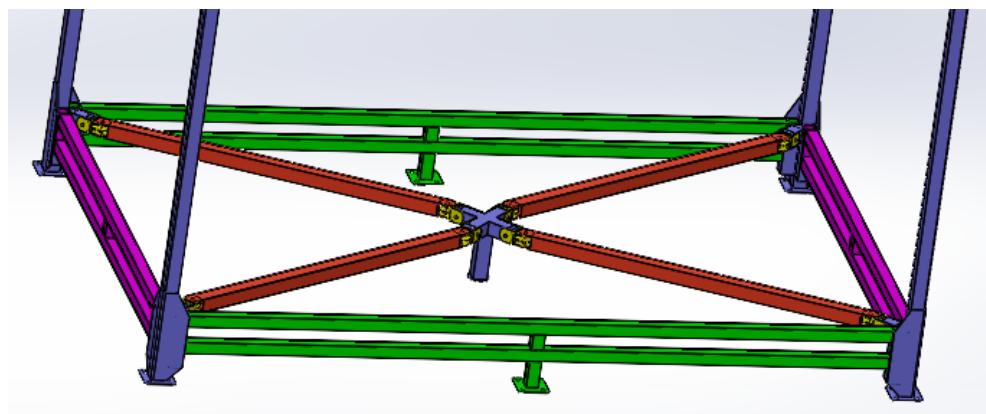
Fixation des barres transversales et longitudinales aux montants verticaux (Legs)
